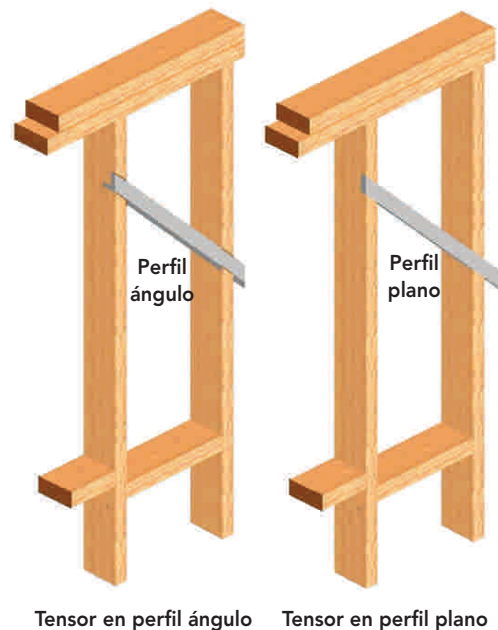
b: Ejemplos de colocación de arriostramientos en perfiles de acero (perfil ángulo y barra plana).
